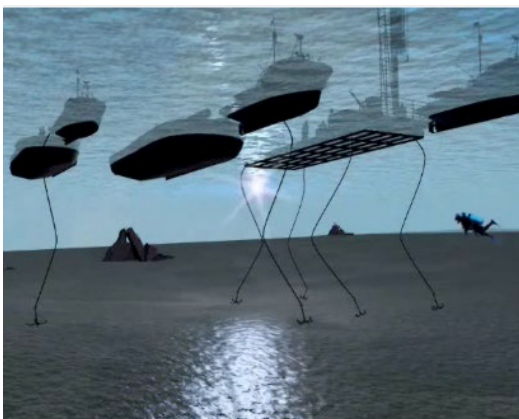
Anclaje de barcazas y ubicación y transporte de pilotes
